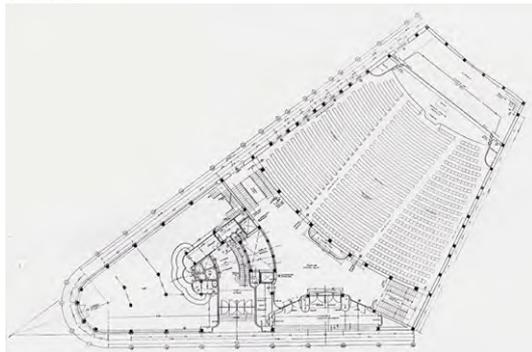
Planta construida del edificio Capitol de Feduchi y Eced
